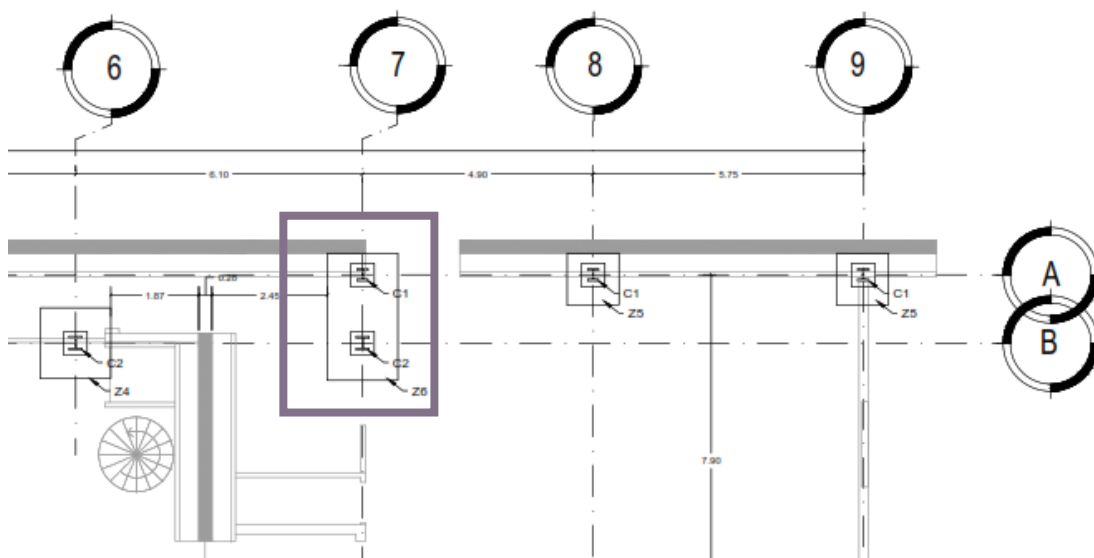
Zapata combinada Z6 2.00x1.50 m con columna W12x40
